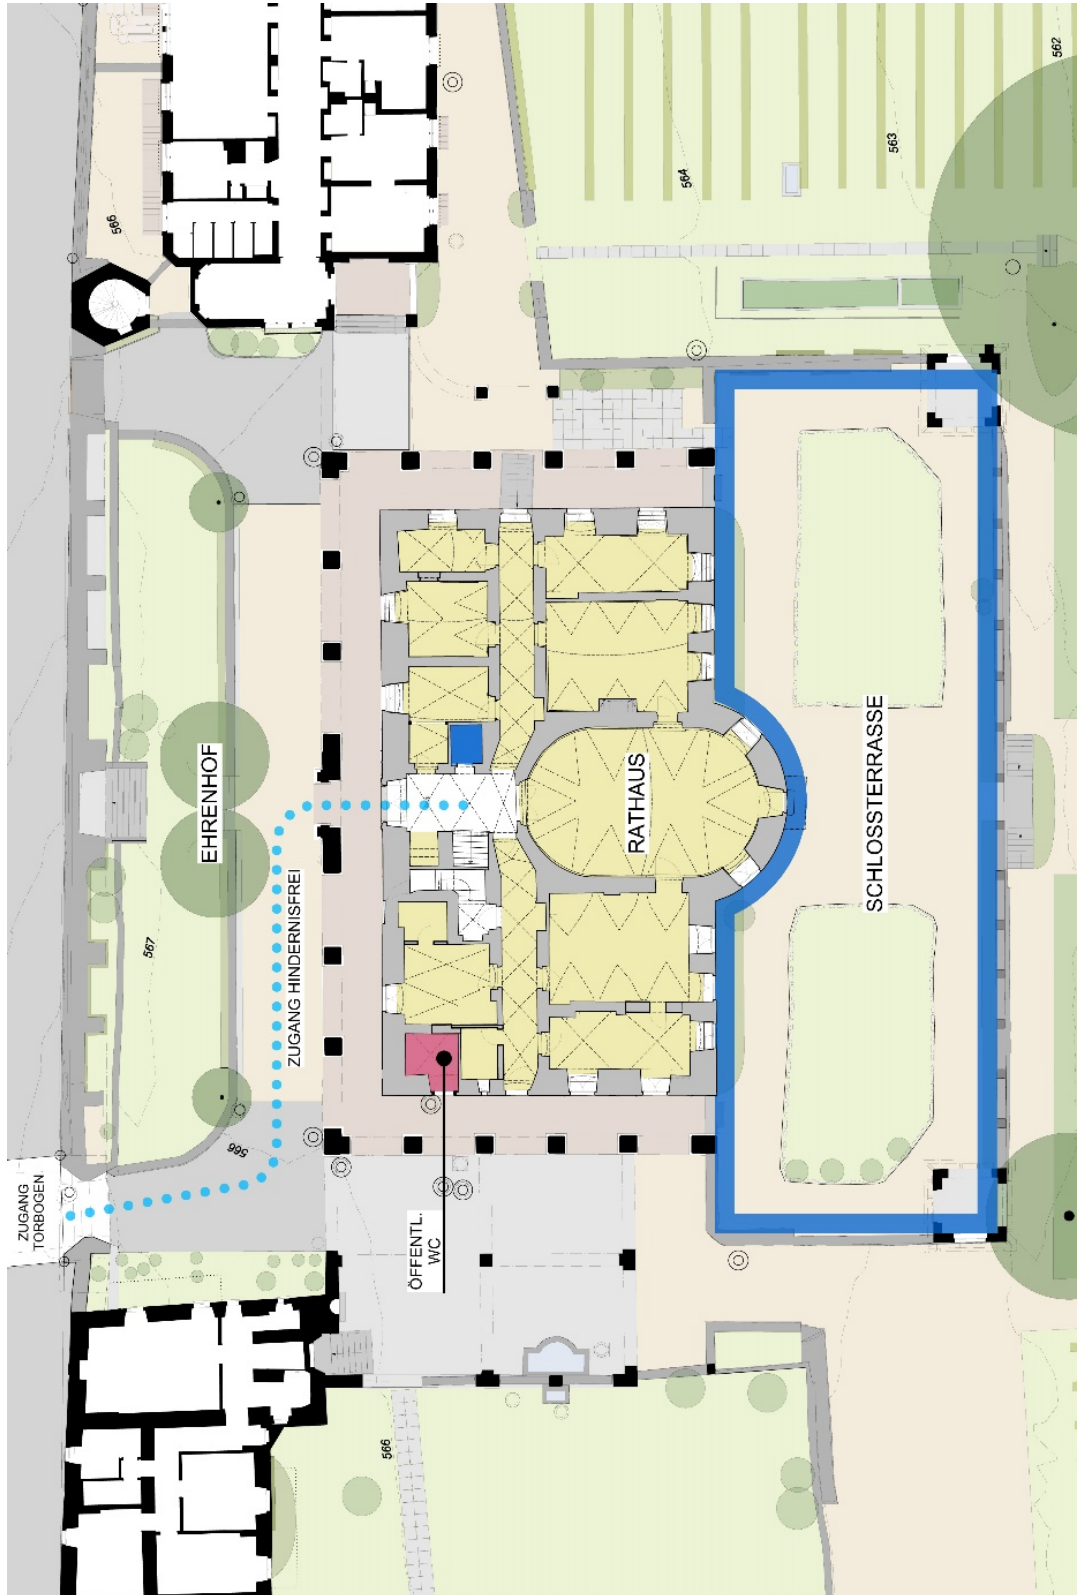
Übersichtsplan Nutzfläche Erdgeschoss
